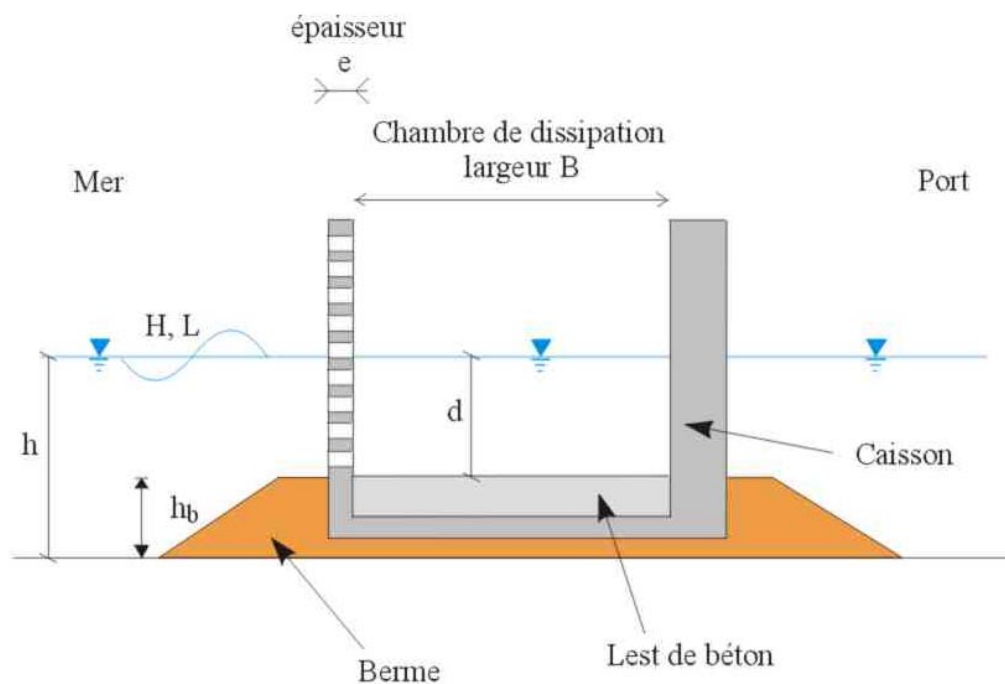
Coupe d'un caisson à paroi perforée de type Jarlan.
